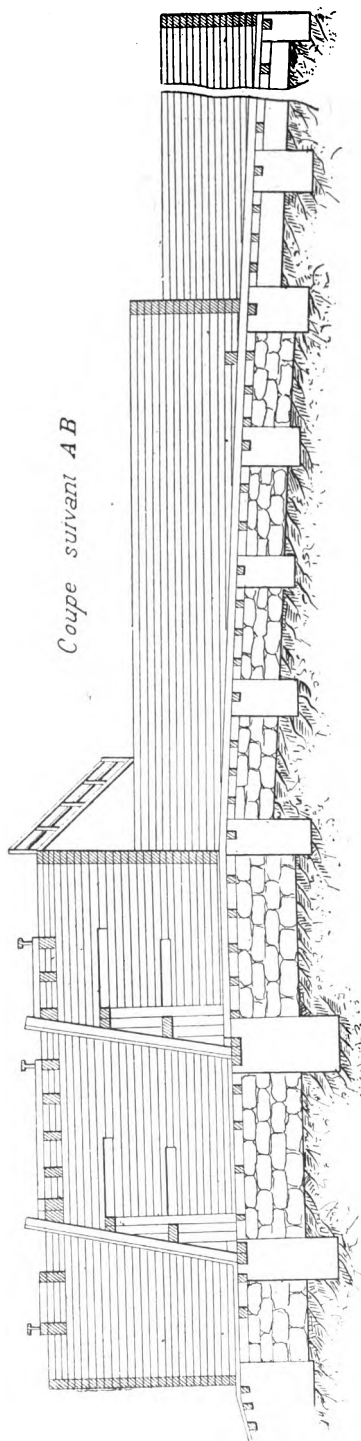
et 16. — Élévation et coupe du barrage de Verkhnévoljsky.
